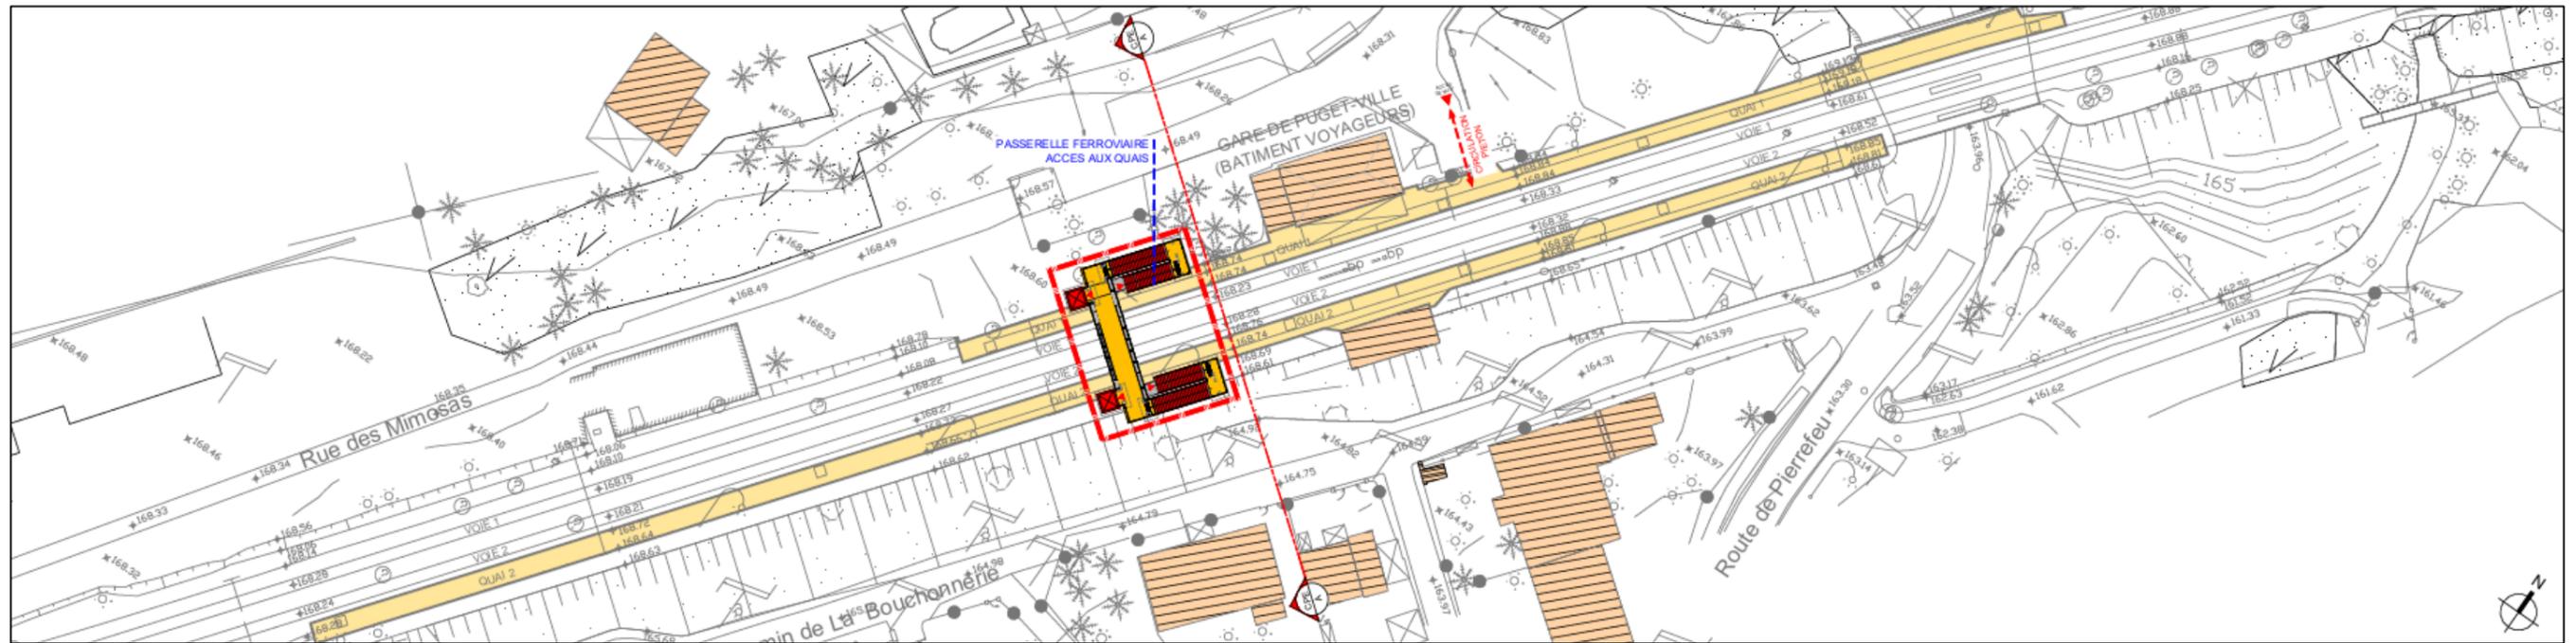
Puget-Ville - plan projet d'implantation de la passerelle (AREP, 2021)
